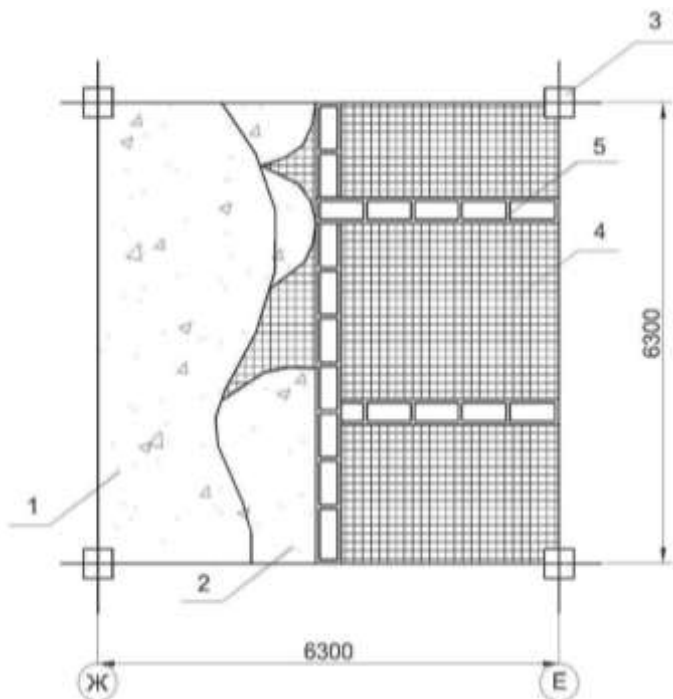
Схема бетонирования перекрытия на делянке:
